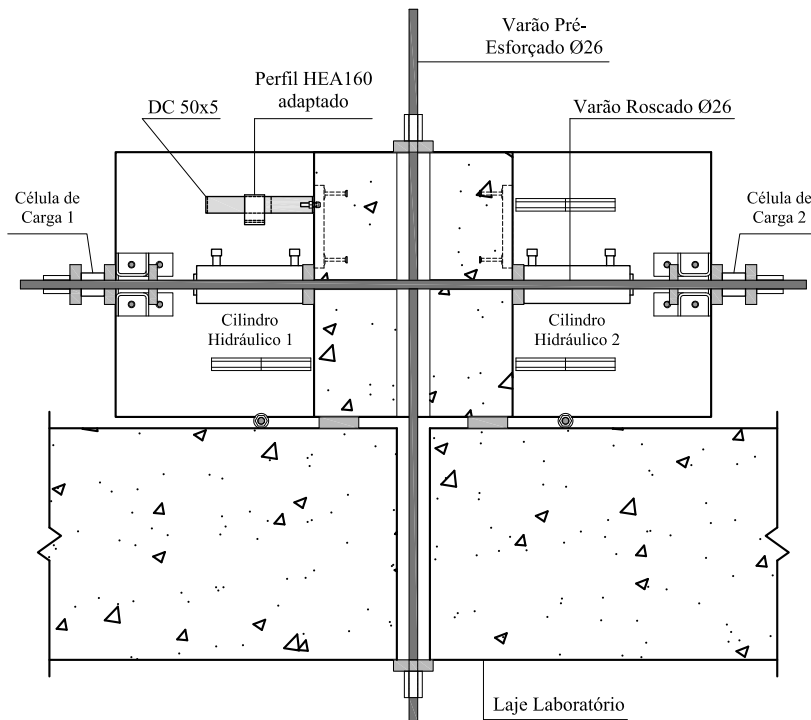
Esquema de ensaio com dispositivos DC 50x5 - Corte A-A
